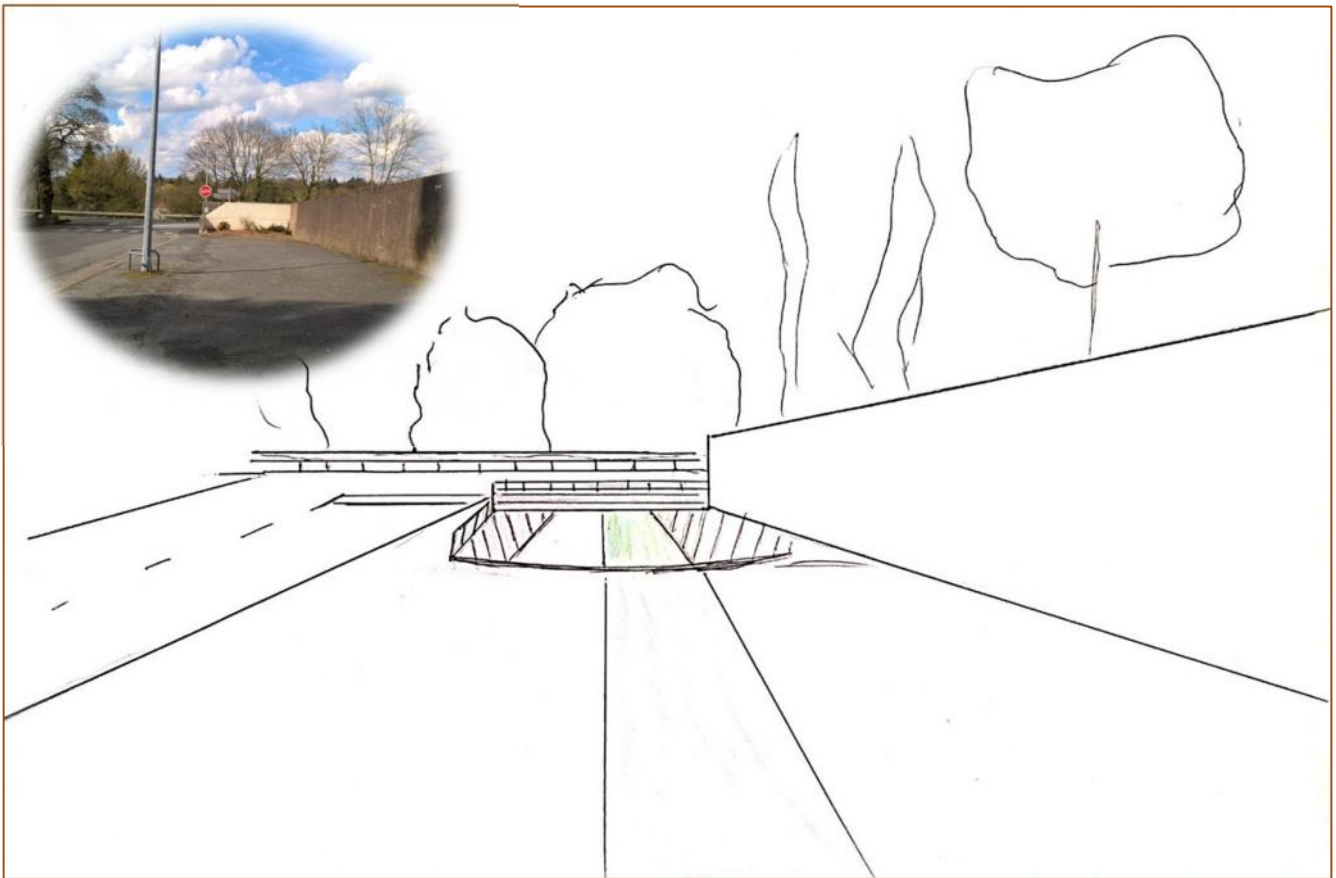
Croquis de la pente permettant de rejoindre le tunnel (réalisation : Félix Blanloeil)
